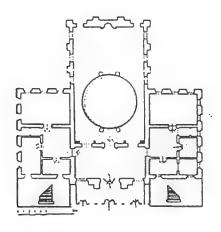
المسقط الأفقي لجامع لآله لي في إستانبول .
